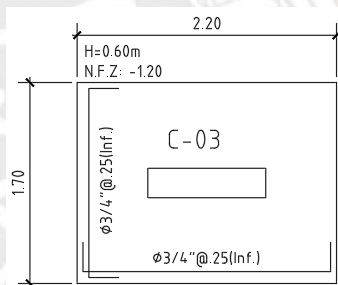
Detalle de refuerzo de la zapata de la columna D/8 (C-03).
